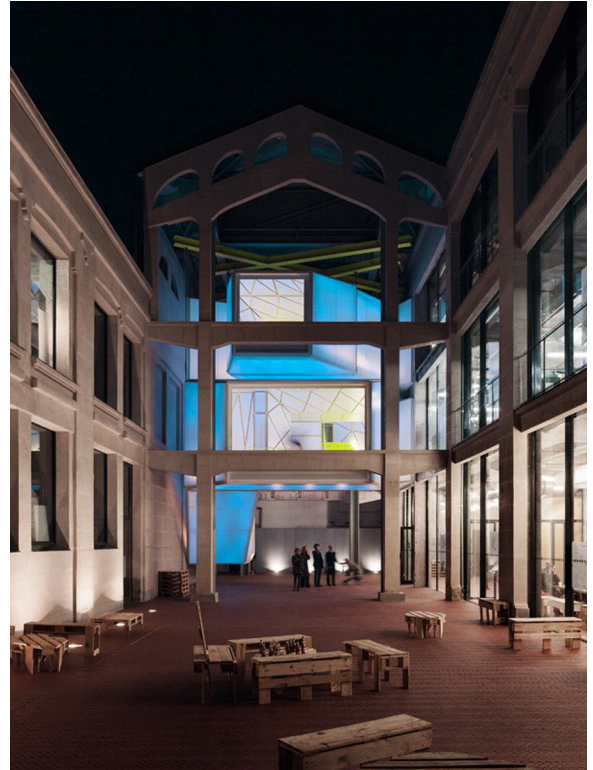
Vista de la nueva estructura metálica así como de las naves originales de hormigón.
